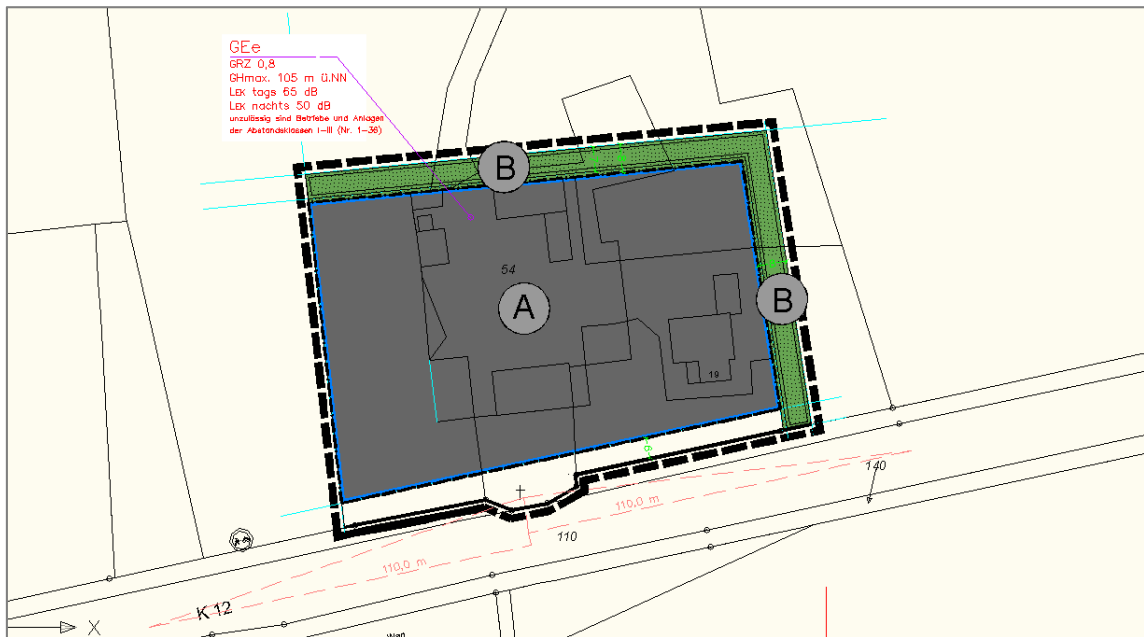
Nutzung der Fläche gem. Entwurf des Bebauungsplans
